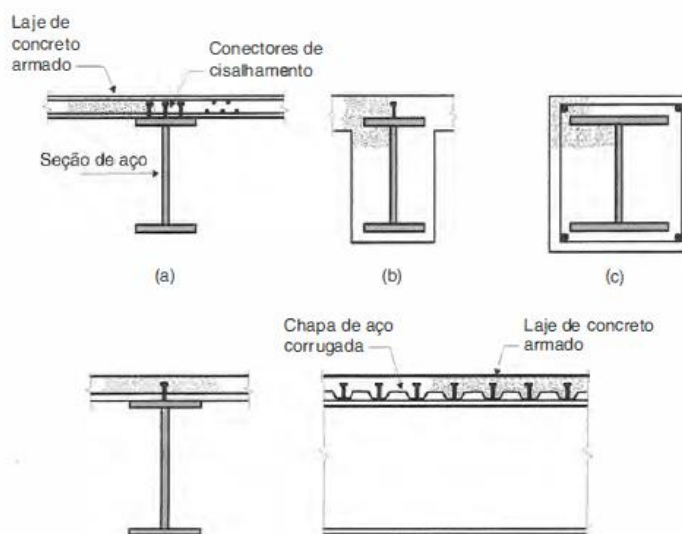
Estruturas mista de aço-concreto. (Fonte: Pfeil, 2008.)
